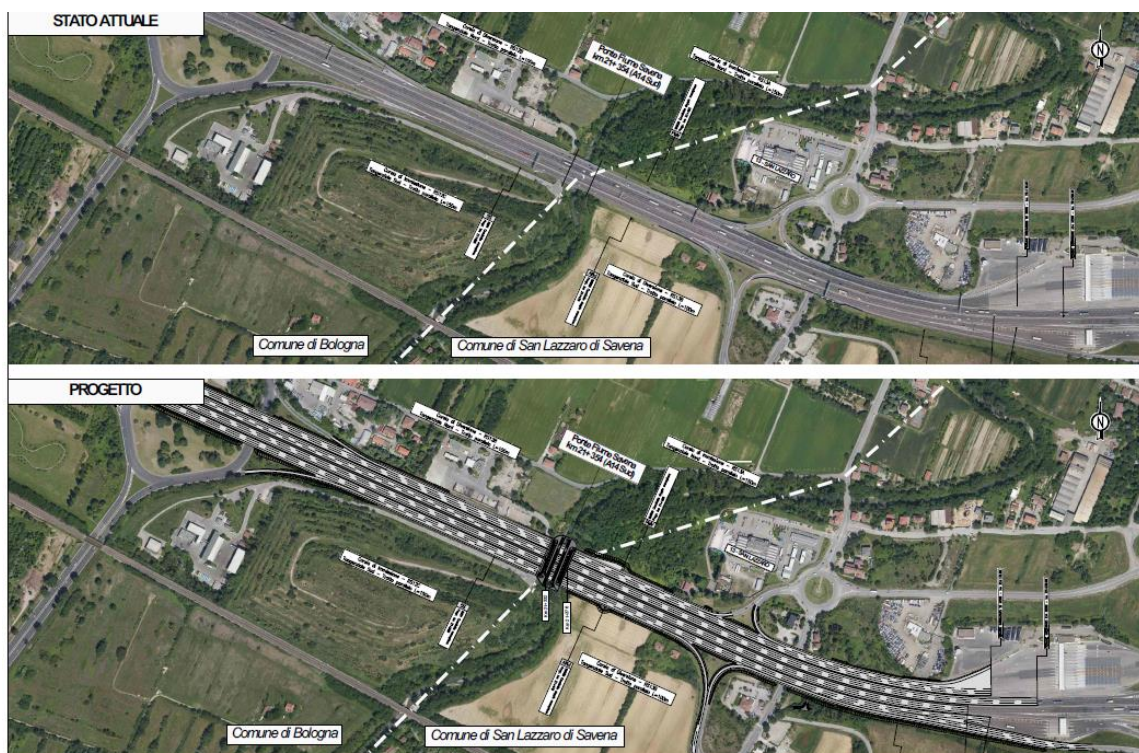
Ortofoto dello stato attuale e del nuovo progetto del ponte sul torrente Savena
